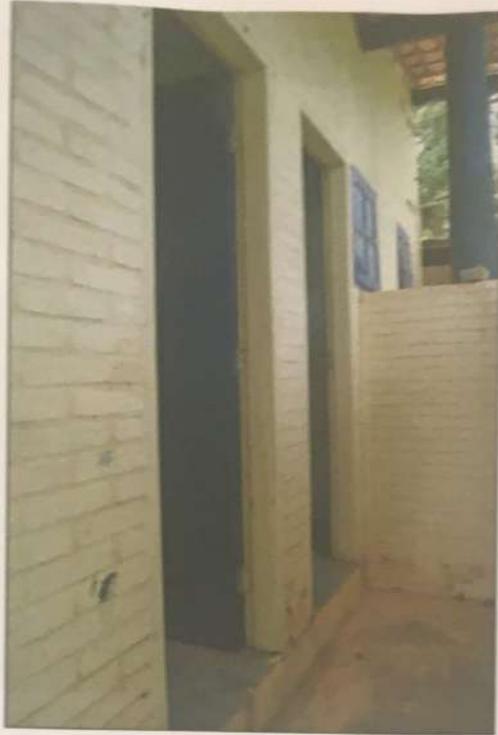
Acesso aos banheiros do rancho da churrasqueira
